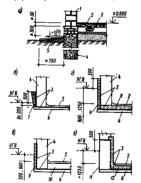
Защита элементов малоэтажных зданий от влаги грунтов:
